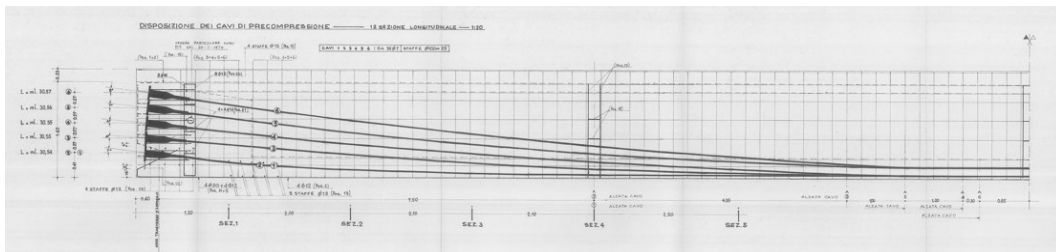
Disposizione dei cavi di precompressione, vista longitudinale
